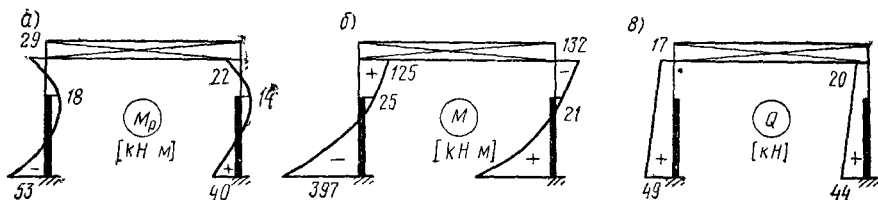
Эпюры усилий от ветровой нагрузки
